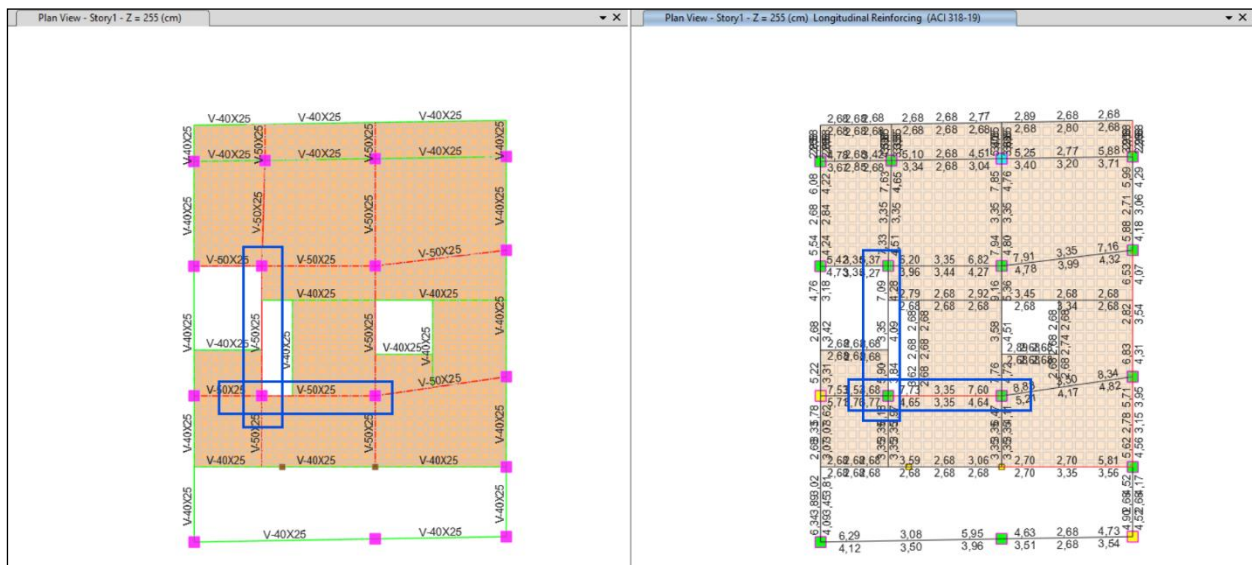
Acero a flexión en vigas de losa nivel 1, alternativa 2 [Autor]
